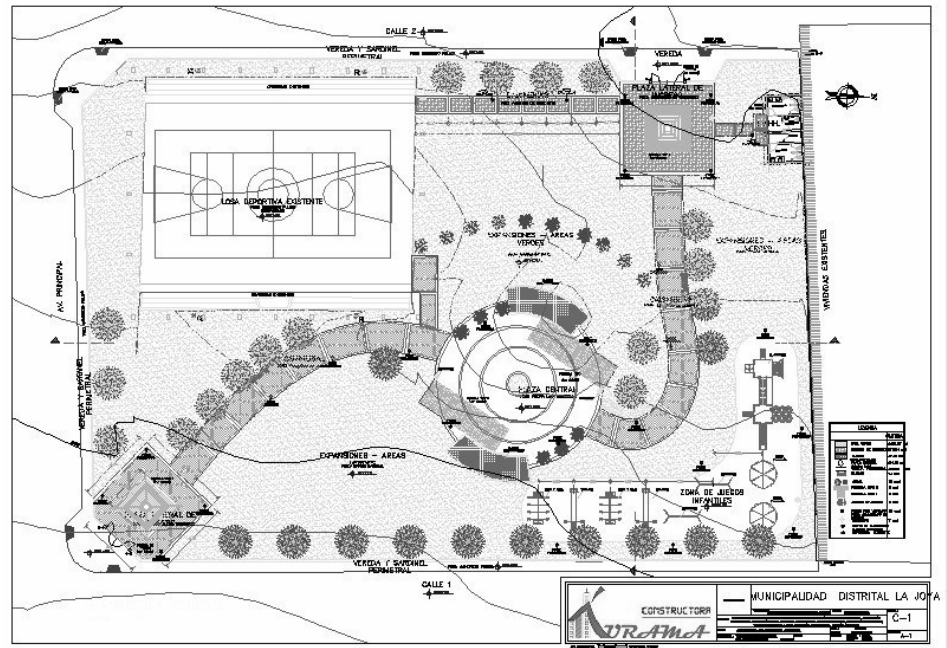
Plano técnico para construcción de Parque La Joya, Arequipa, Perú
